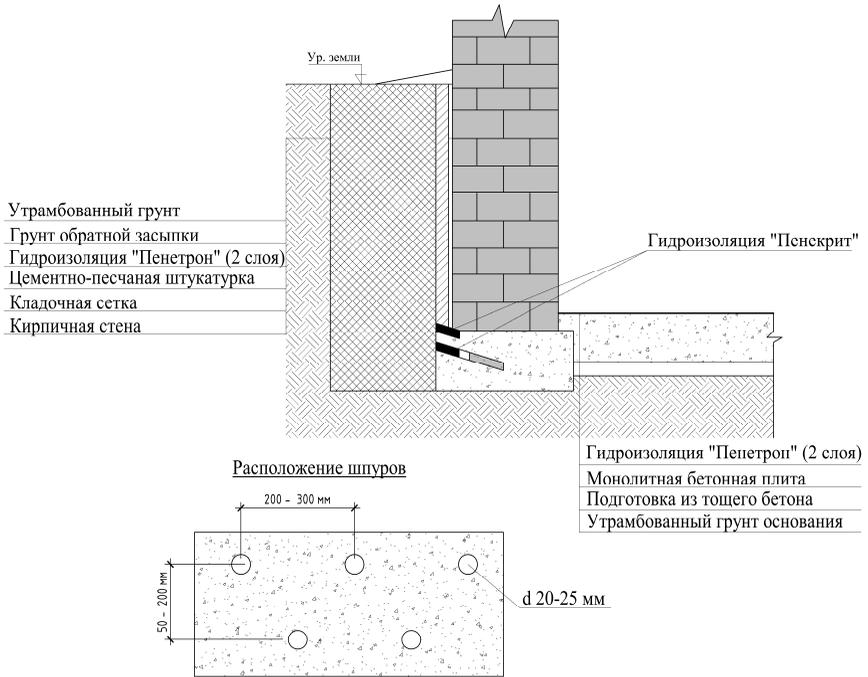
Б. Внешняя гидроизоляция по кирпичной стене
